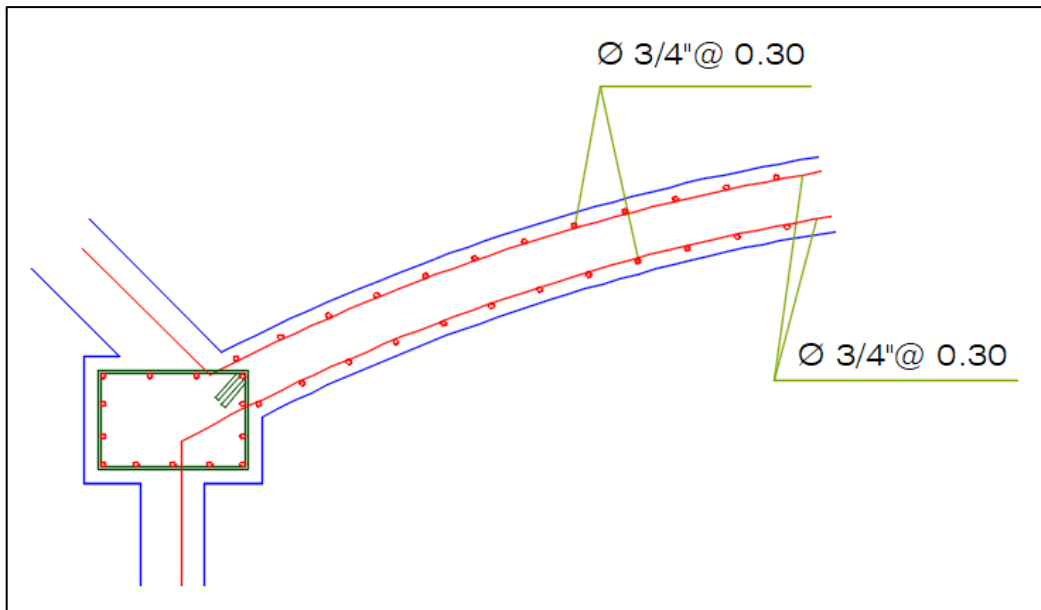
Plano de detalle de distribución de acero de la cúpula inferior.
